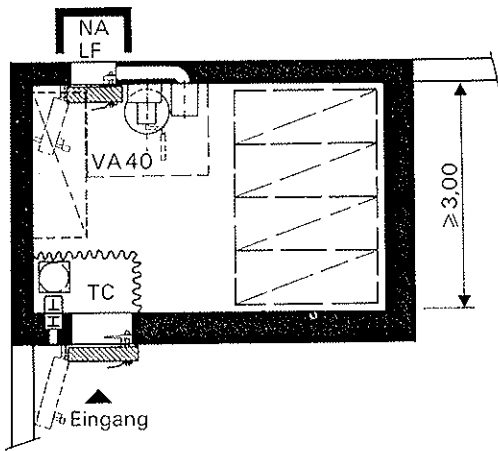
Grundrissform für 9 Schutzplätze (Bodenfläche $\geq 10 \text{ m}^2$)
